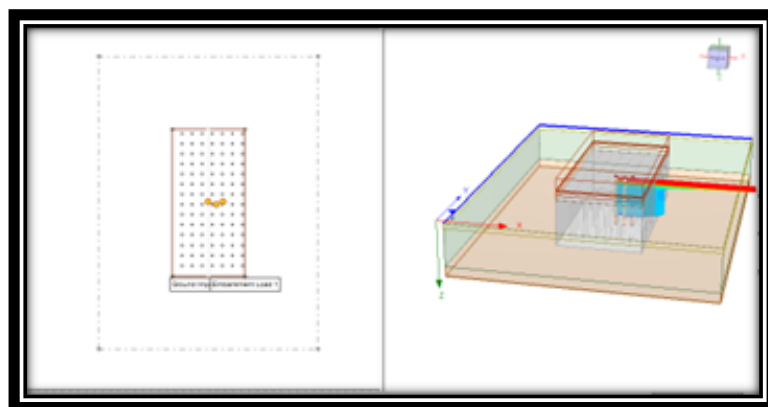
Perspectiva em planta e 3D do aterro final após a inserção de todas as propriedades.
